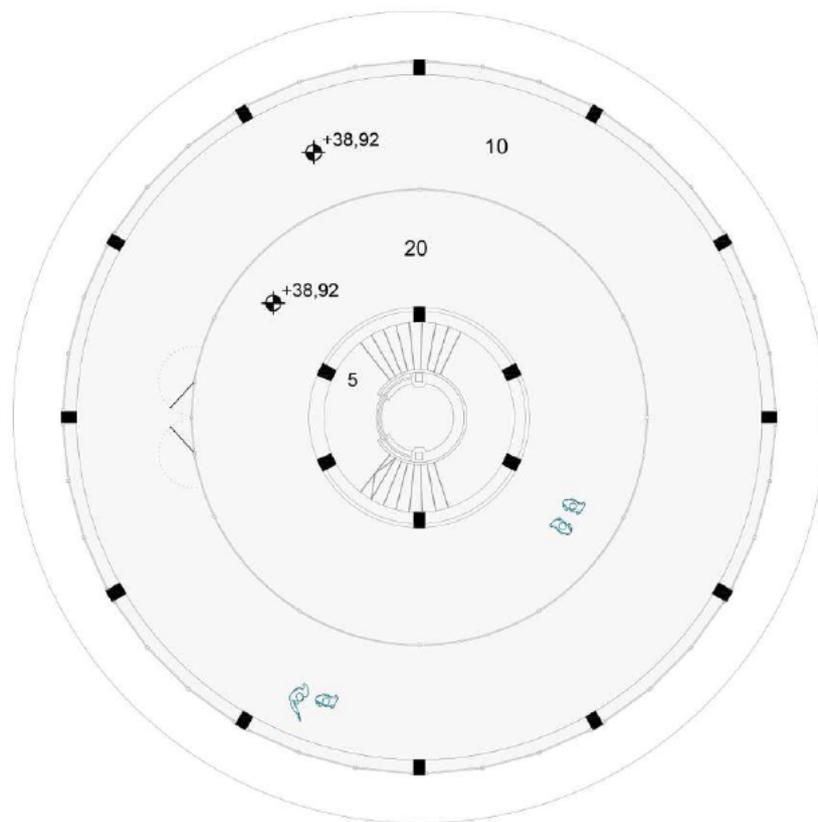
2.8 Grundriss 7.Obergeschoss
